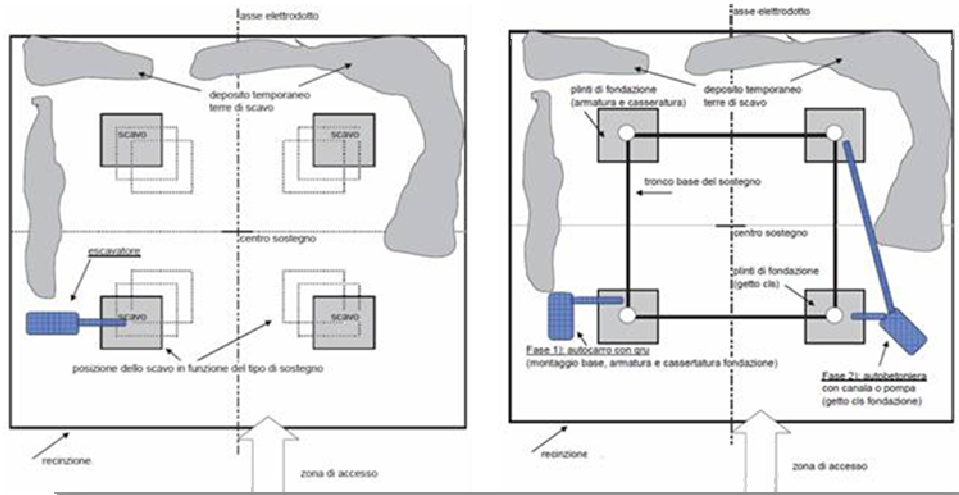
Planimetria tipologia del microcantiere per una fondazione superficiale: a sinistra nella fase di scavo delle fondazioni; a destra nella fase di getto per la realizzazione dei plinti di fondazione.
